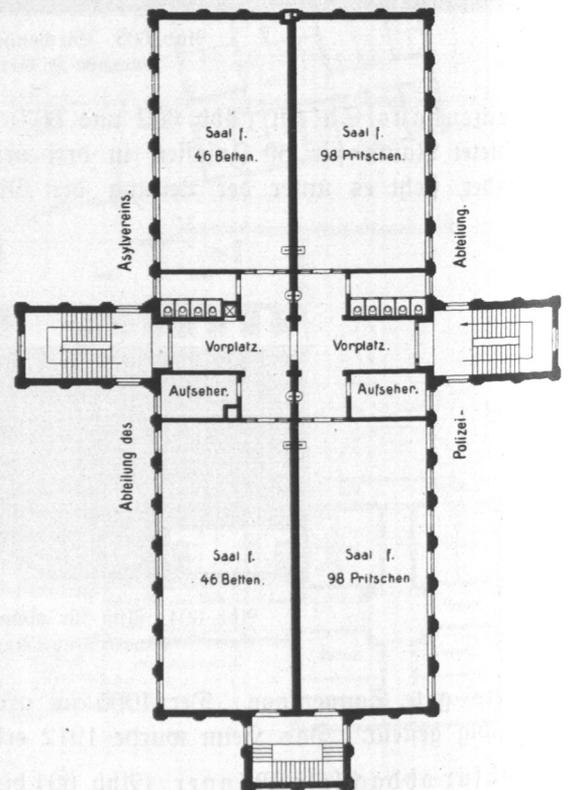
Asyl für obdachlose Männer, Obergeschoß, Grundriß.
